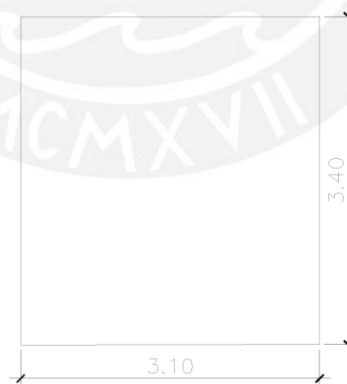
Dimensiones de la zapata para la placa PL-04.
